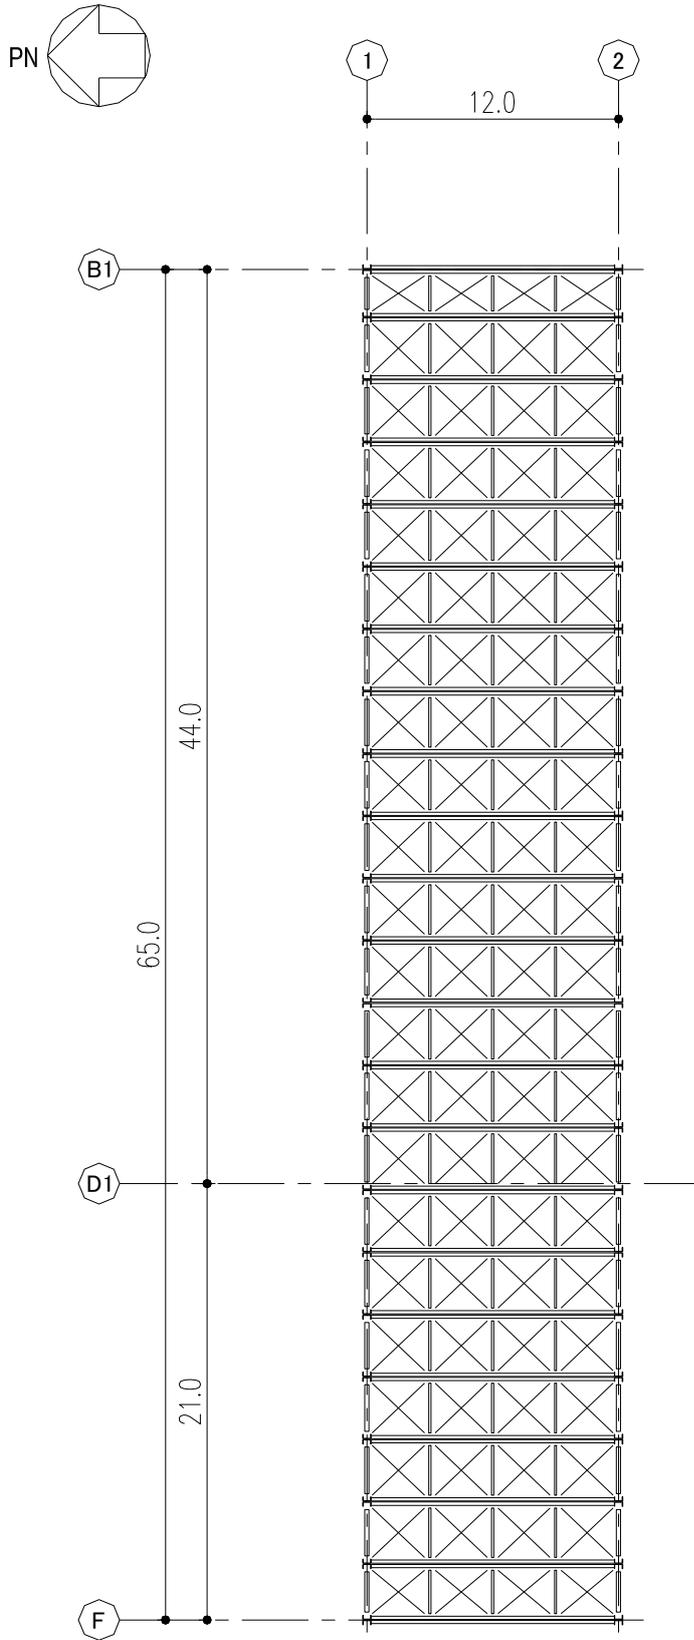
設備棟 屋根平面図 設計 G.L. +6.6 (単位 : m)
